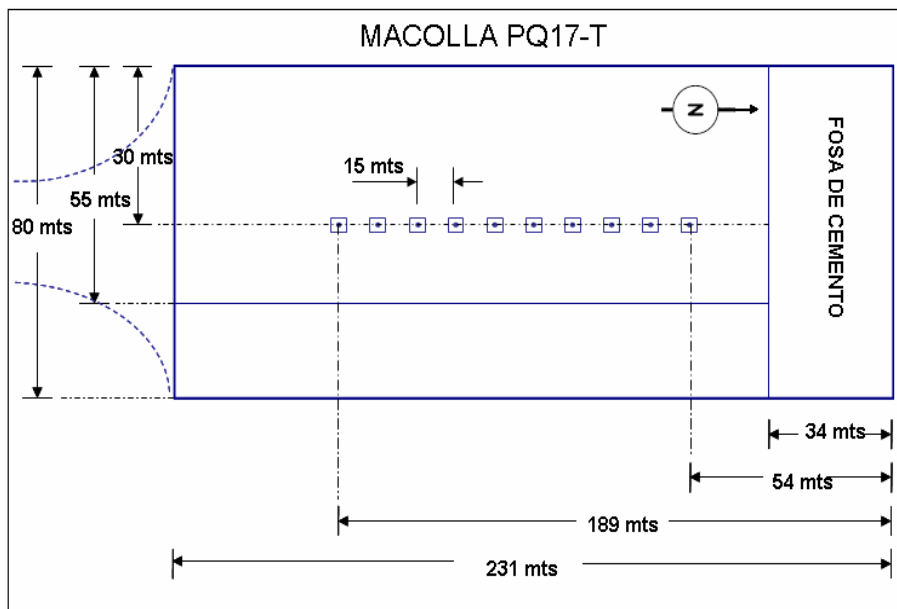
Vista en planta de la Macolla PQ17-T.
